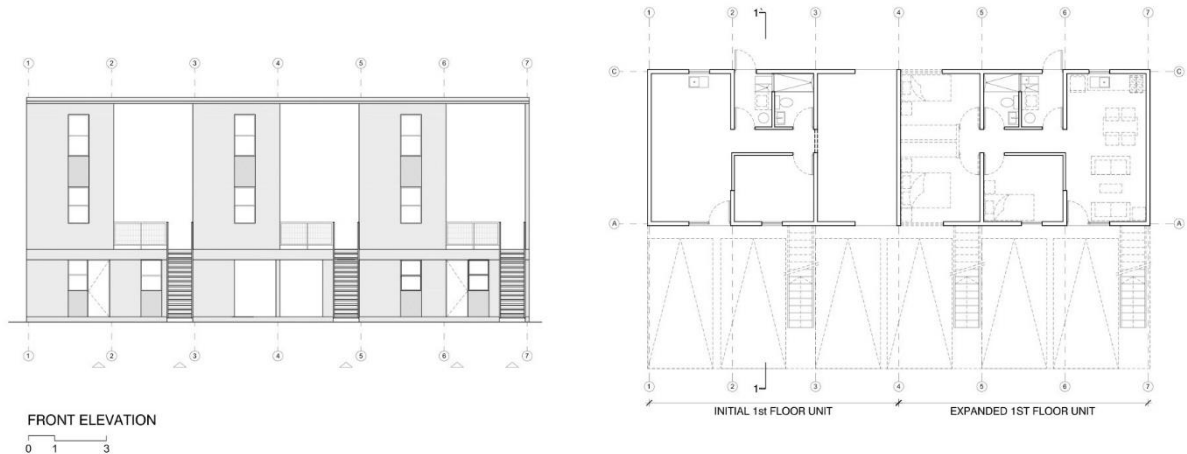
Elevação das *Viviendas* (à esquerda); Planta tipo do pavimento térreo (à direita).
